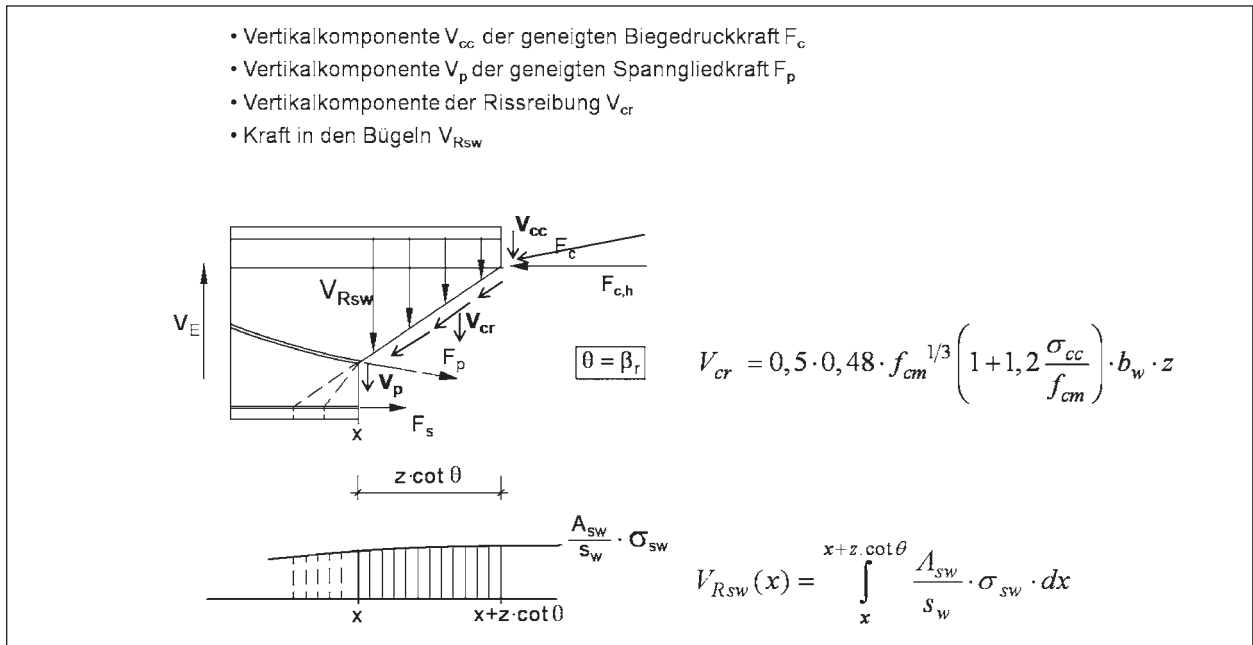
Querkrafttraganteile Fachwerk mit Rissreibung
